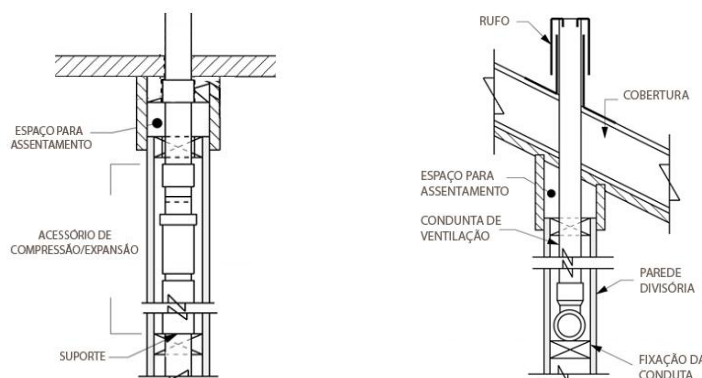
Juntas de assentamento ao nível do pavimento e cobertura [3]
